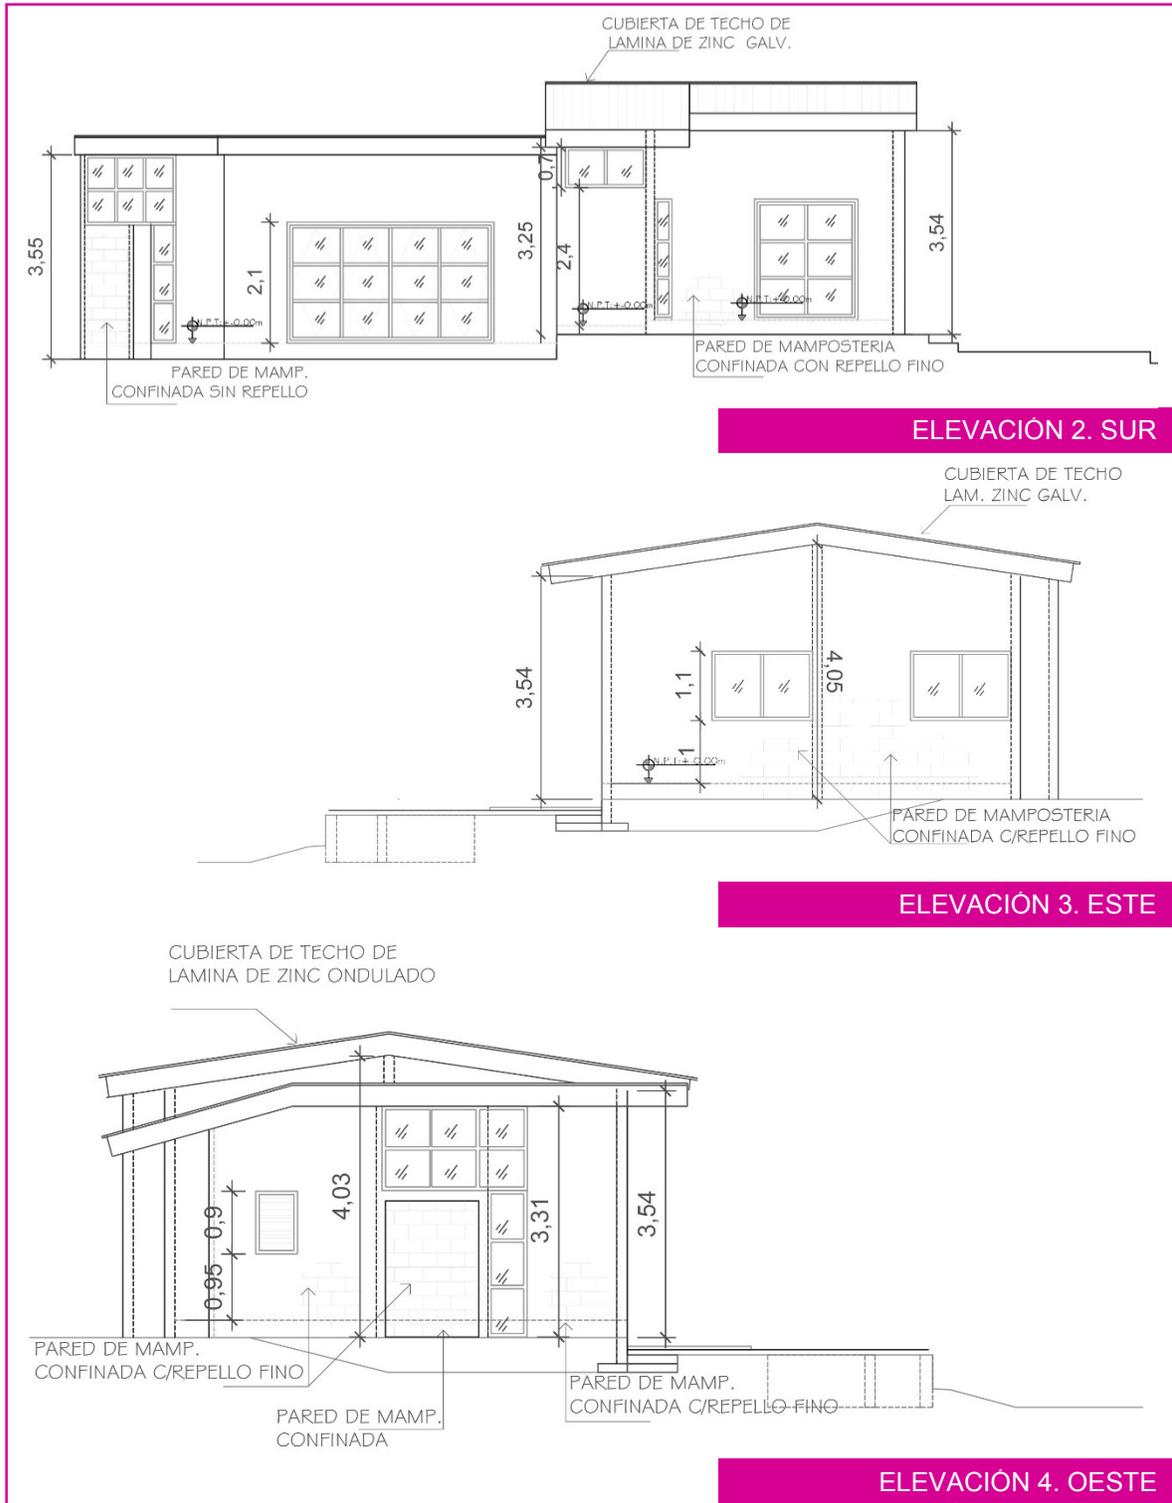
Elevaciones Arquitectónicas. Fuente: Autor. Programa: Autocad.
